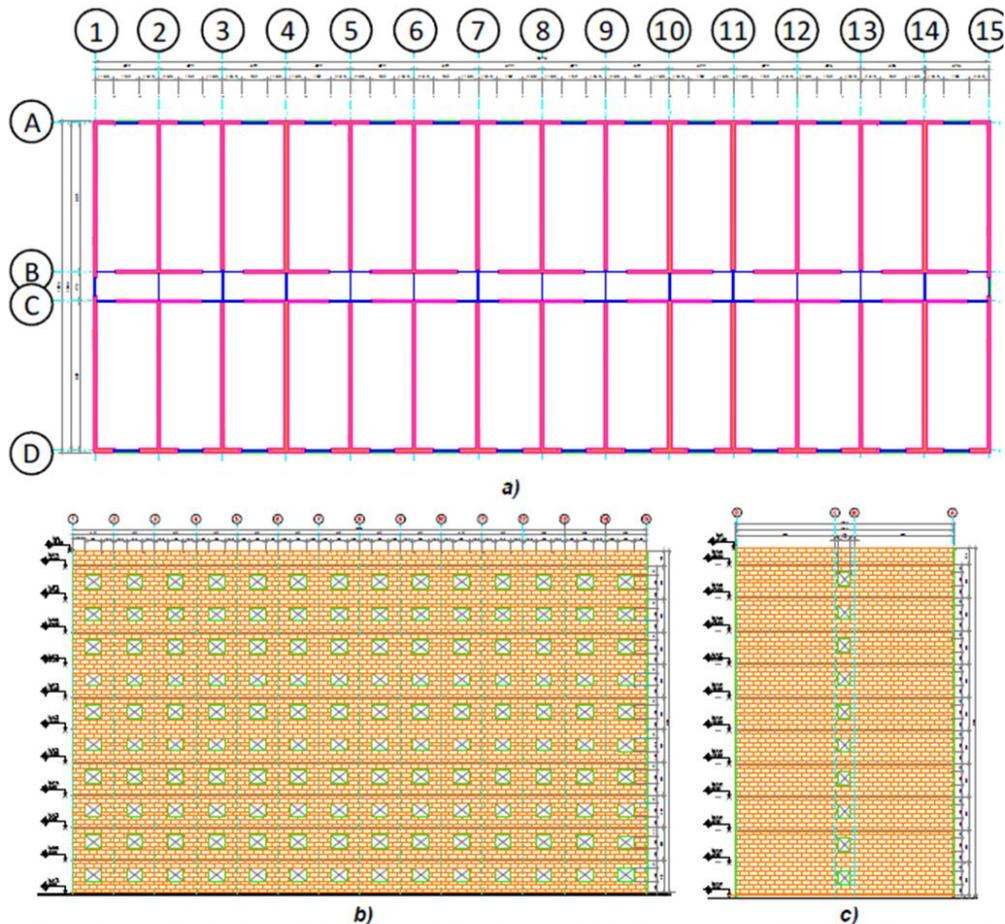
Configuración arquitectónica: a) Vista en planta; b) Vista en elevación, dirección larga; c) Vista en elevación, dirección corta
